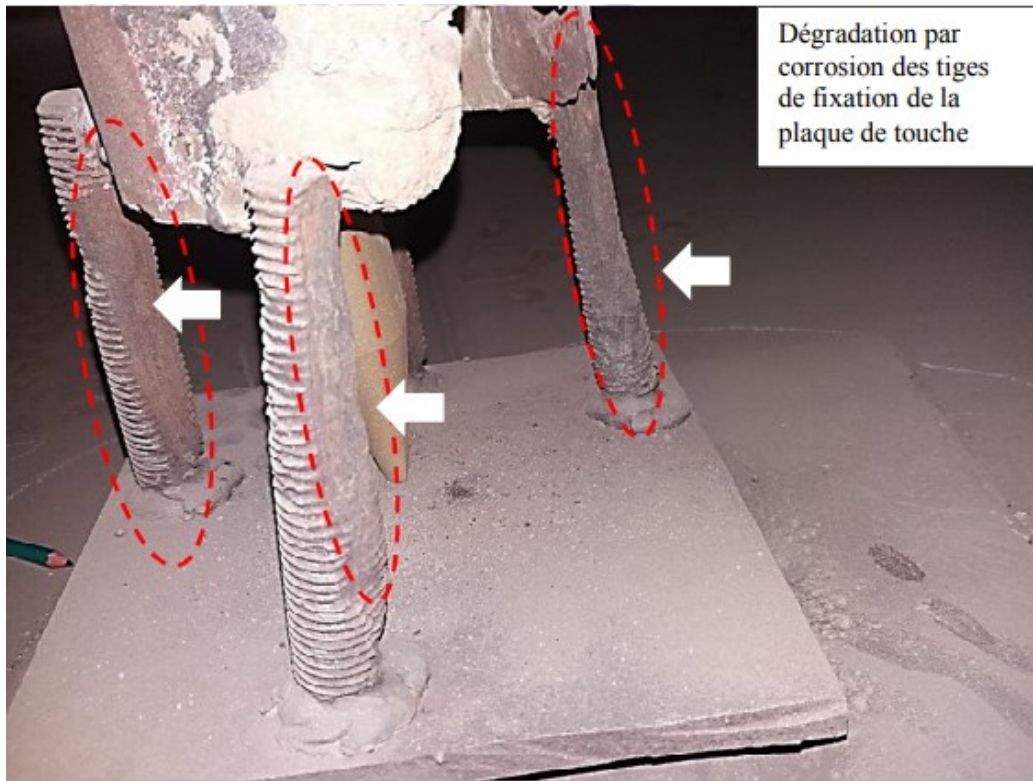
Dégradation par corrosion des tiges de fixation de la plaque de touche
